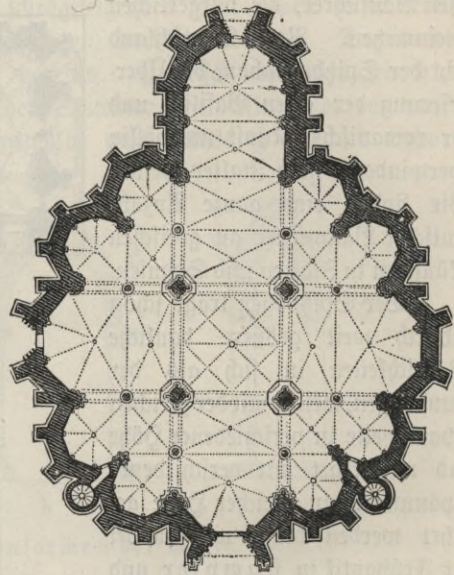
Liebfrauenkirche zu Trier, Grundriß.
